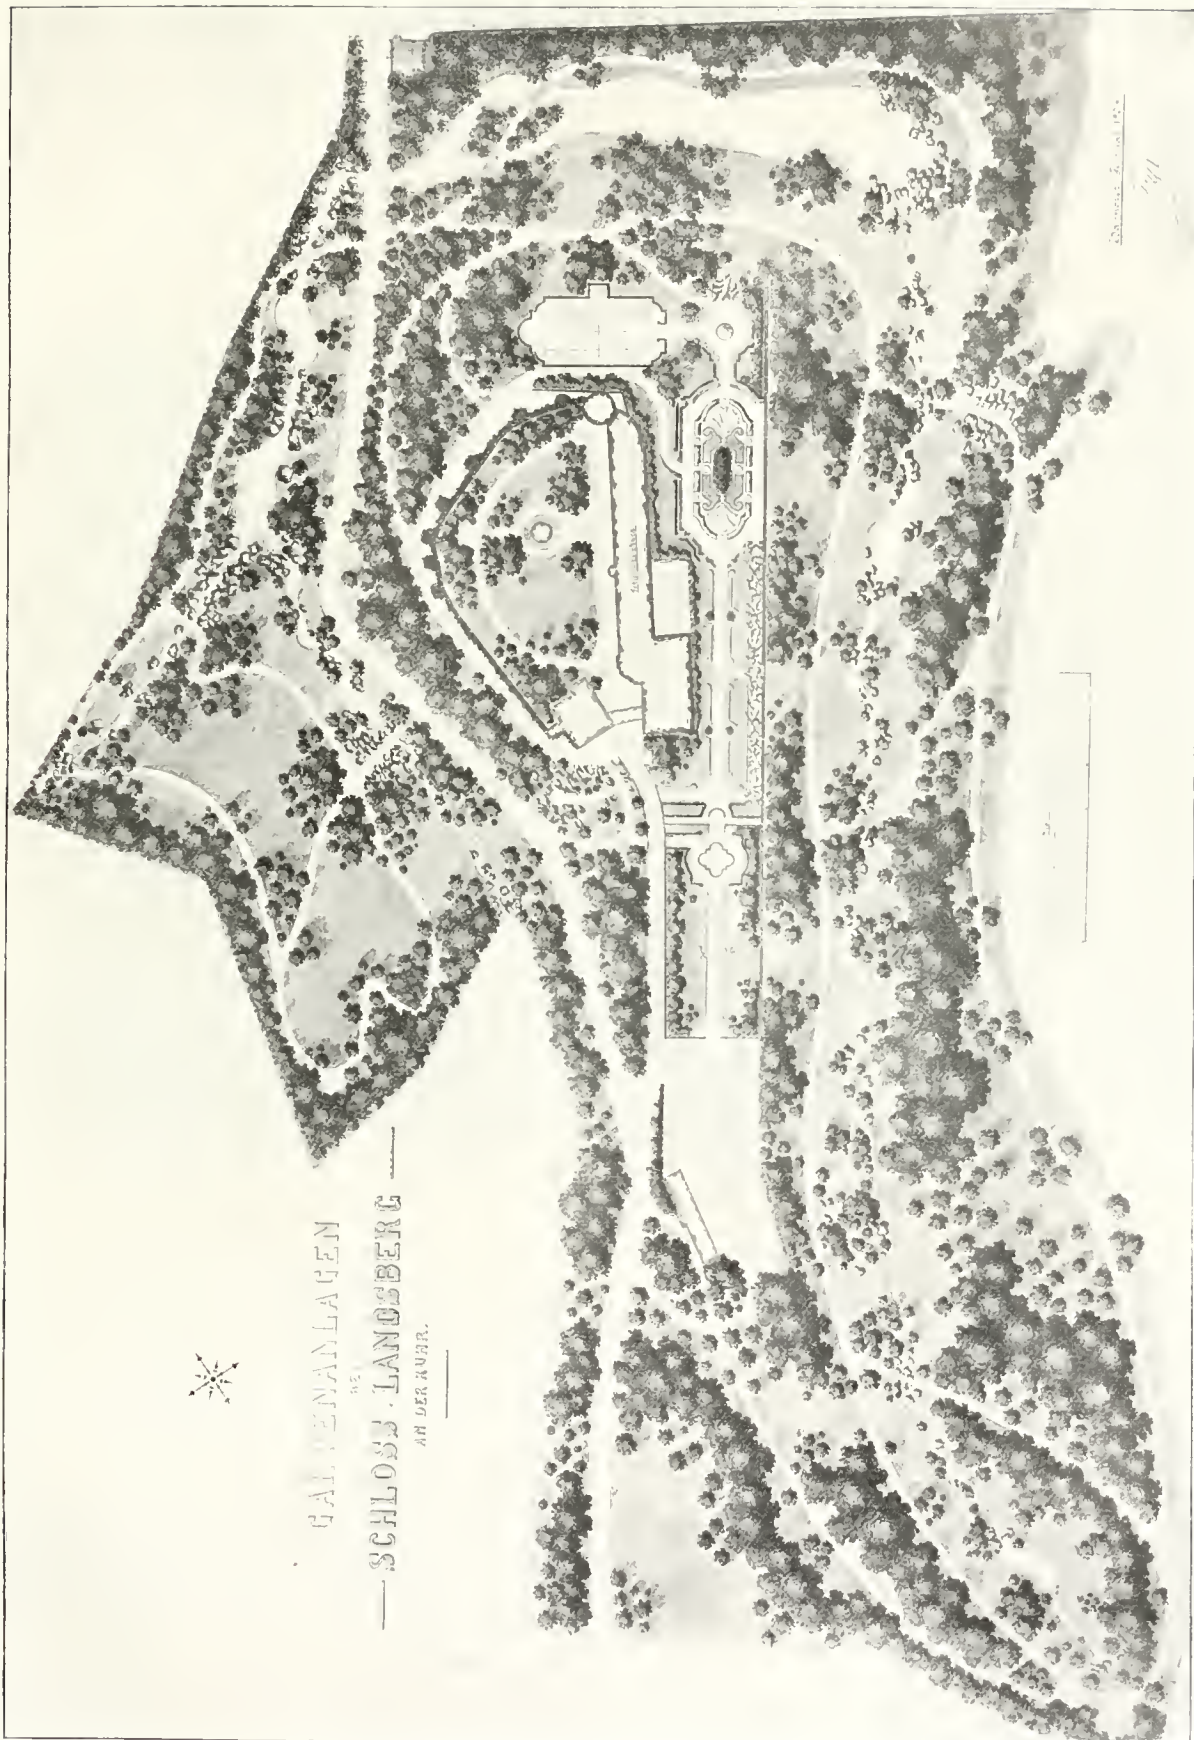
Lageplan der Parkanlagen zu Schloß Landsberg a. d. Ruhr.
